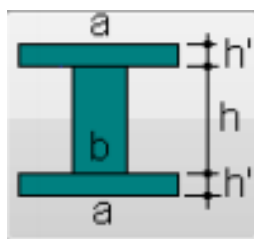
Colagem dos componentes estruturais da Viga de perfil I de MLC
